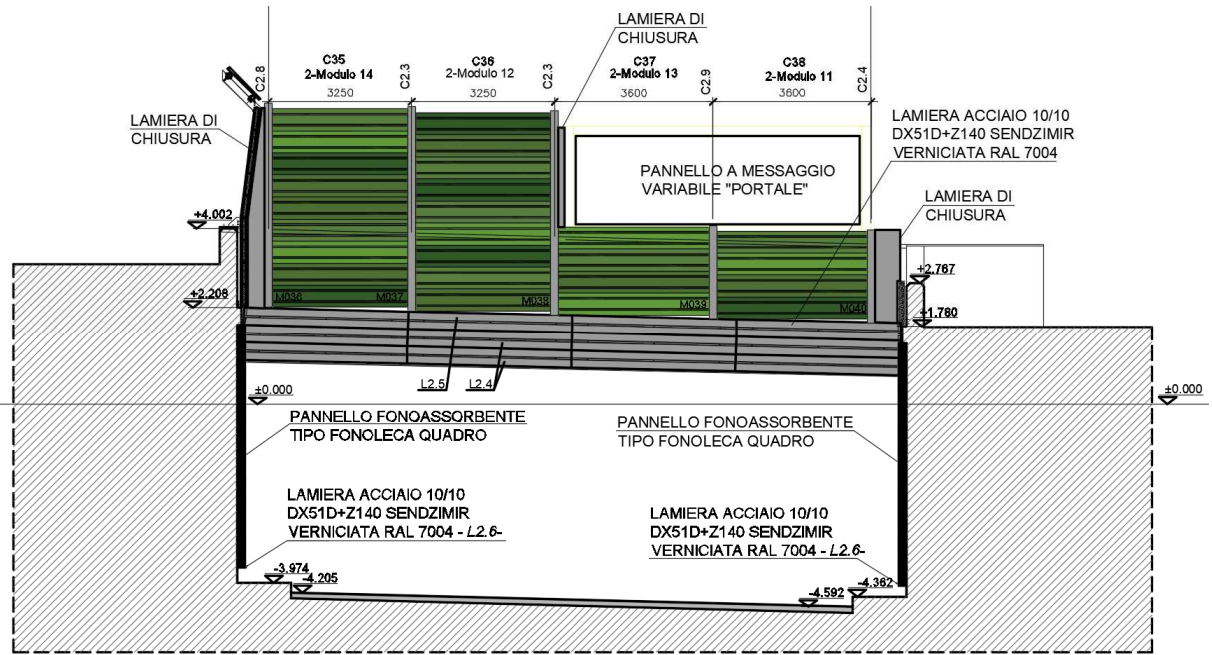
Prospetto della barriera dell'ambito 2 – lato mare
